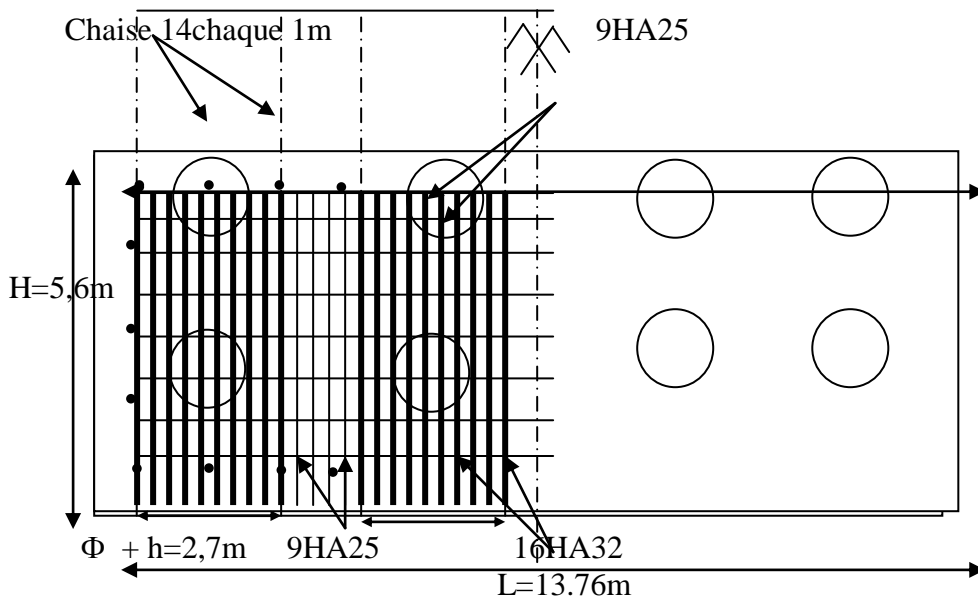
Ferrailage de la semelle (nappe inférieure)
